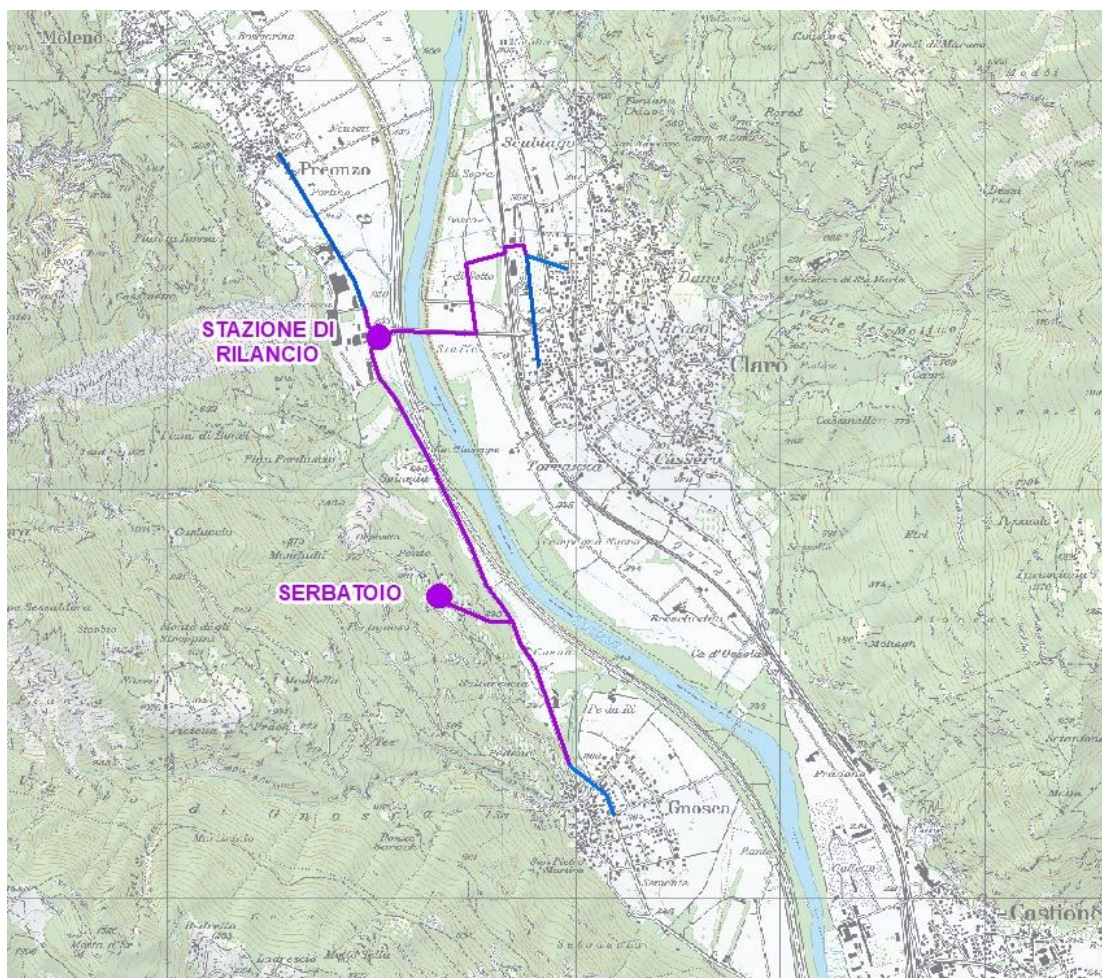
Planimetria nuove condotte, serbatoio e stazione di rilancio
